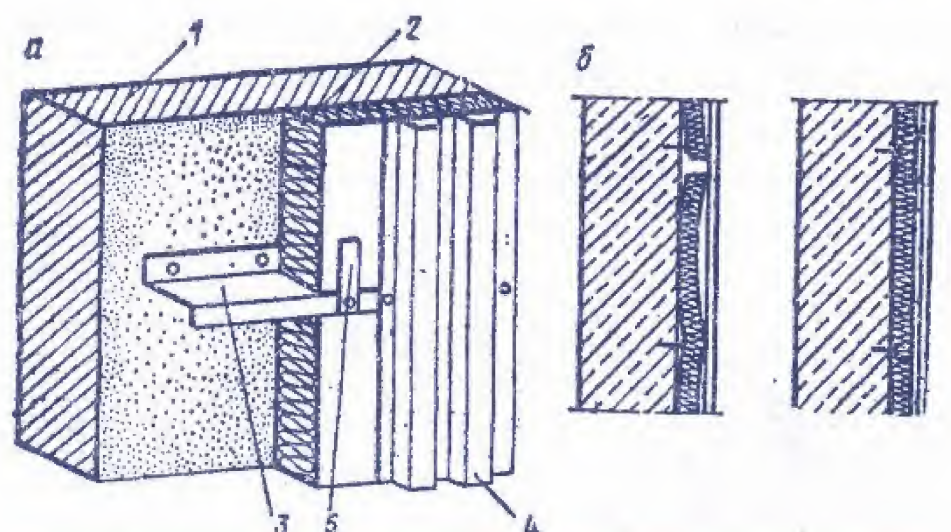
Кріплення утеплювача з мінераловатних плит до бетонної стіни: 1 — бетонна стіна; 2 — плити утеплювача; 3 — оцинкований металевий елемент; 4 — профільований металевий настил; 5 — металевий кріпильний елемент
